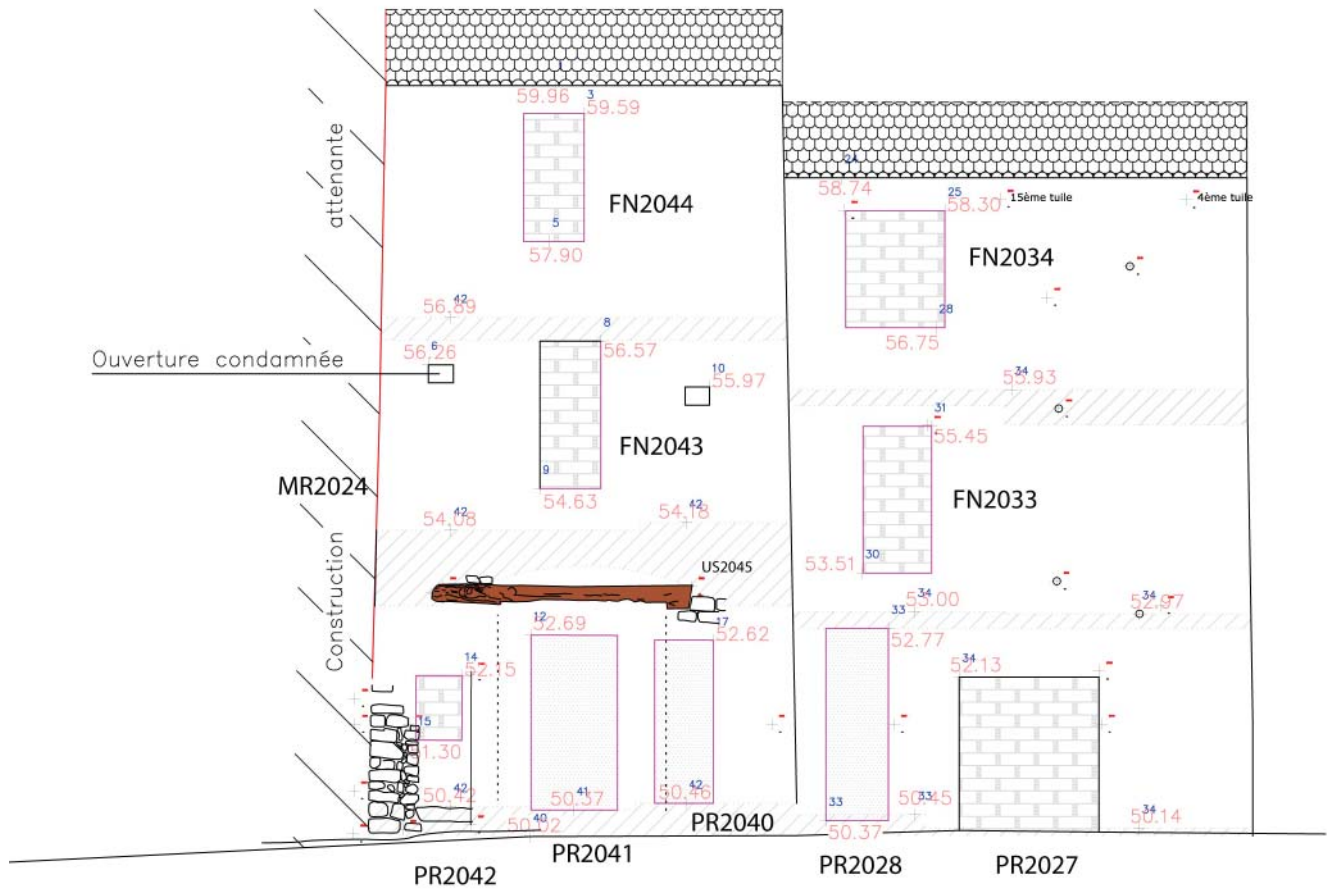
Impasse Paul Bert, façade de la parcelle 129
